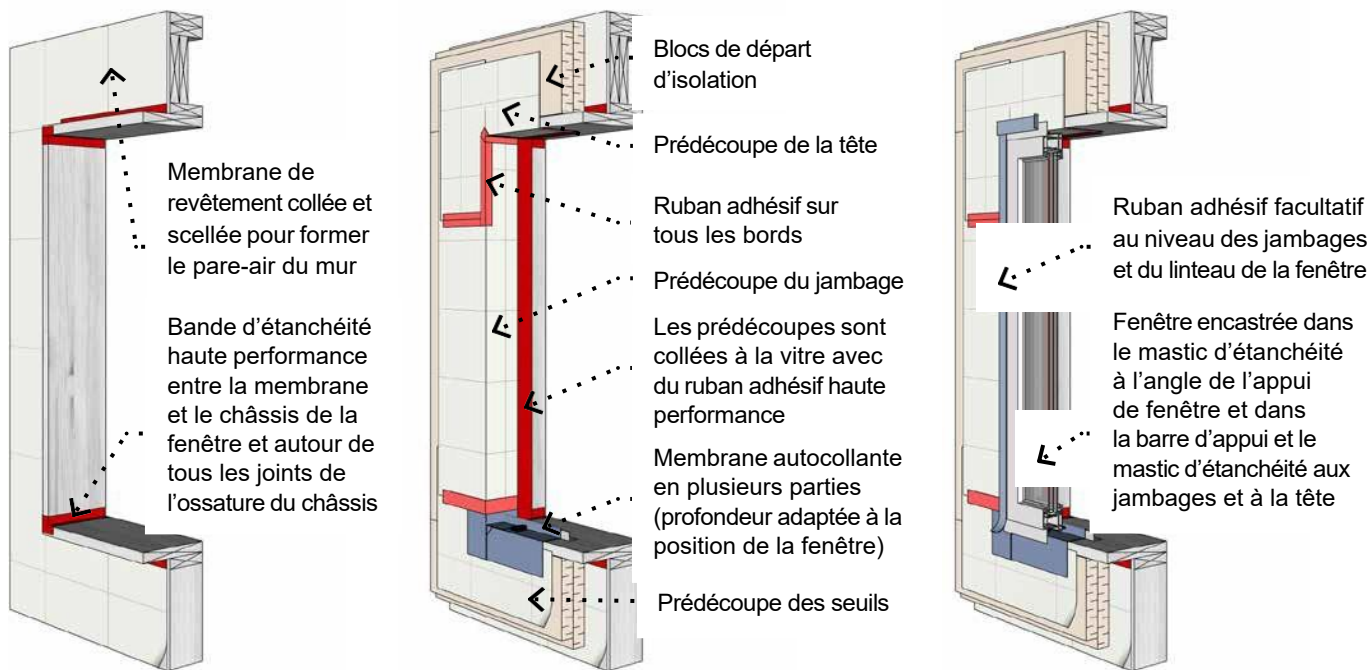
Étanchéité à l'air d'une fenêtre à ouverture brute (gauche), installation d'une membrane prédécoupée (centre) et installation d'une fenêtre à brides (droite)
